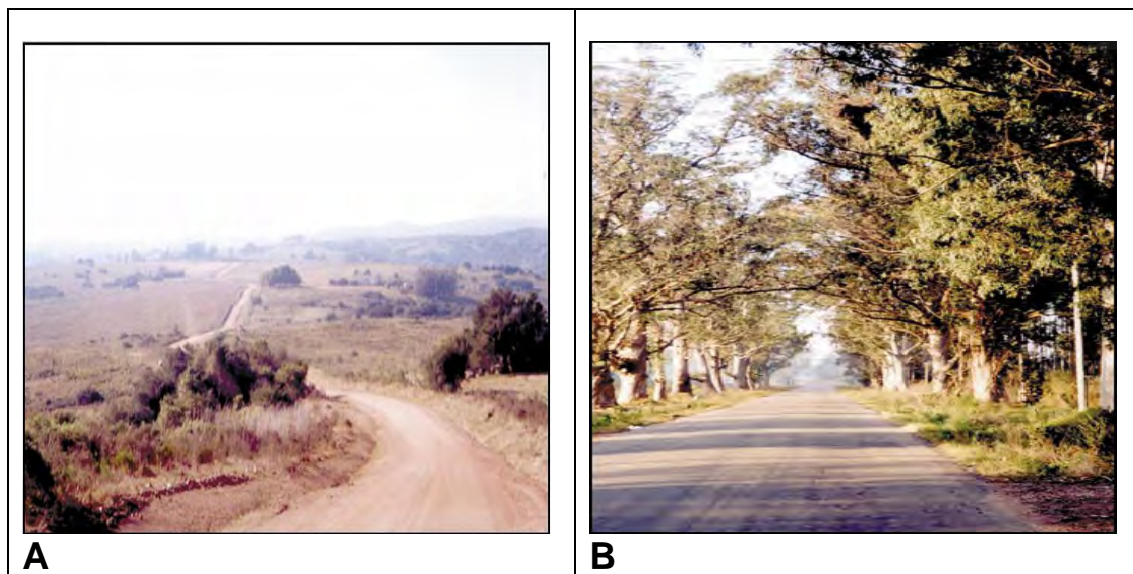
Carreteras de terracería (A) y pavimentada (B)
